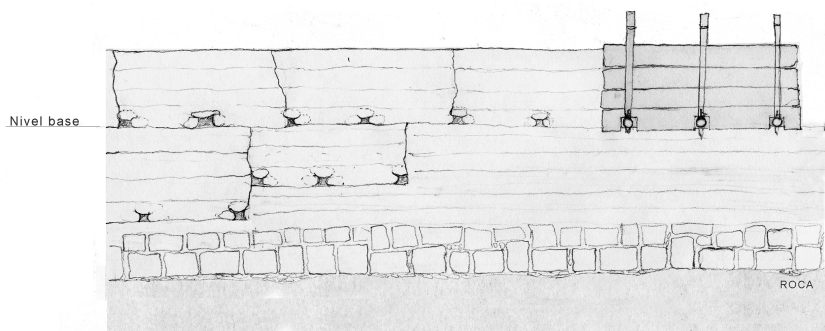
Esquema de alzado del proceso constructivo. Alzado extramuros de la figura 10 en el que aparecen niveles de agujales, sin un orden aparente, motivado por las rasantes de la roca en la cara interior (fuente: Estefanía Herrero García)
